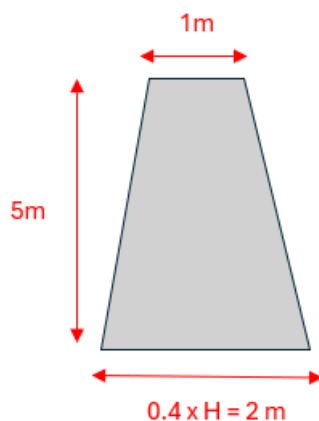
Dimension ouvrage de fermeture (coupe transversal)
